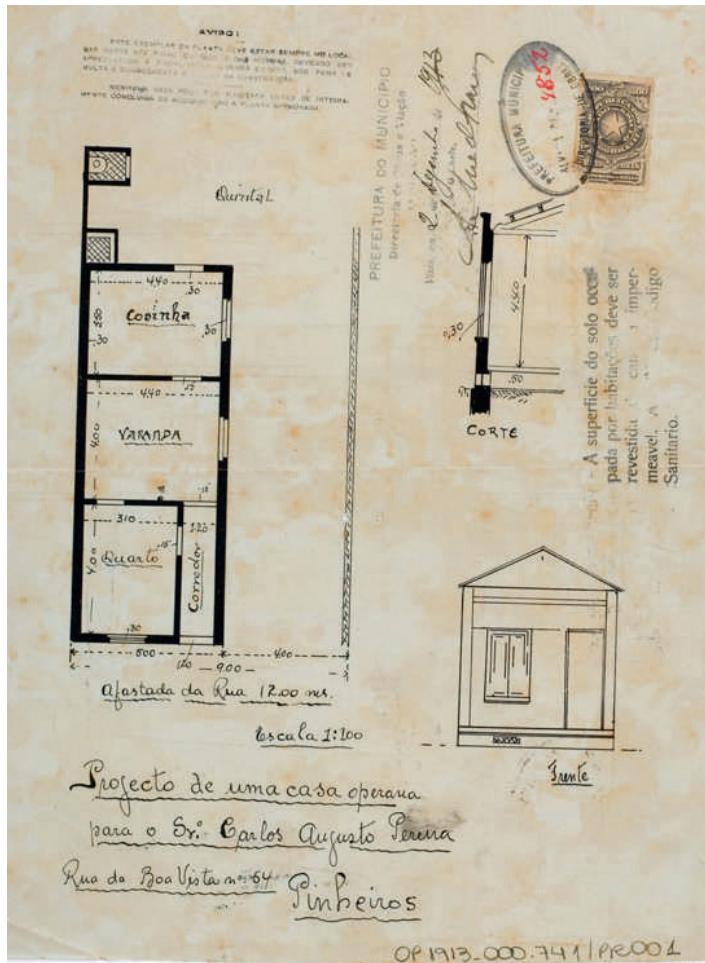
Casas térreas de planta tradicional. Fonte: Vaz, 1985, p.52
